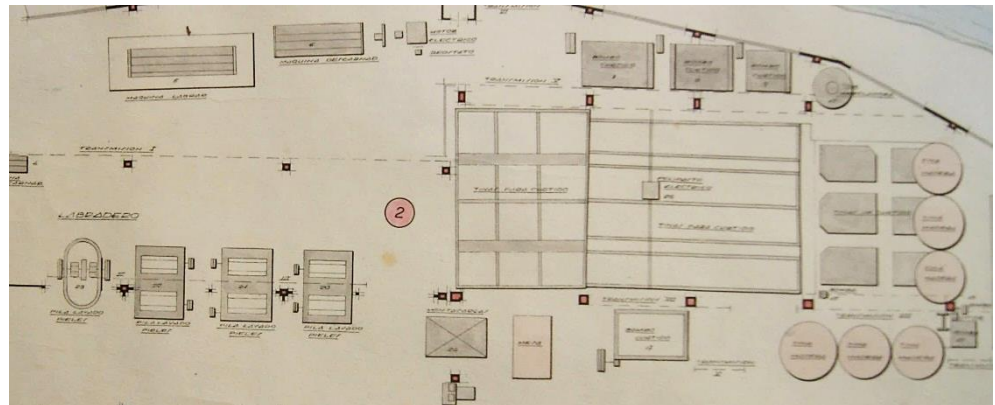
Planta general de la fábrica de Antzuola y detalle de la zona de las pilas de lavado y las tinis de curtido. (LENBUR s.d.)
